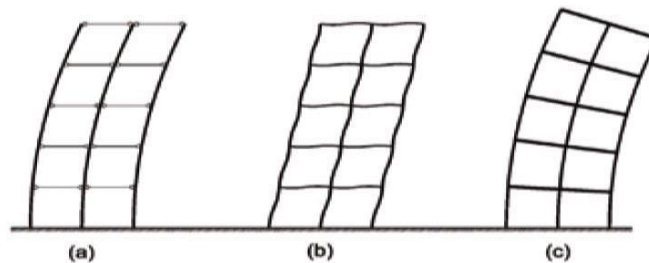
Deformaciones de estructuras a base pórtico sometidas a diferentes acciones laterales; a) vigas de rigidez despreciable, b) vigas de rigidez normal, c) vigas muy rígidas (Astiz, 2014).
